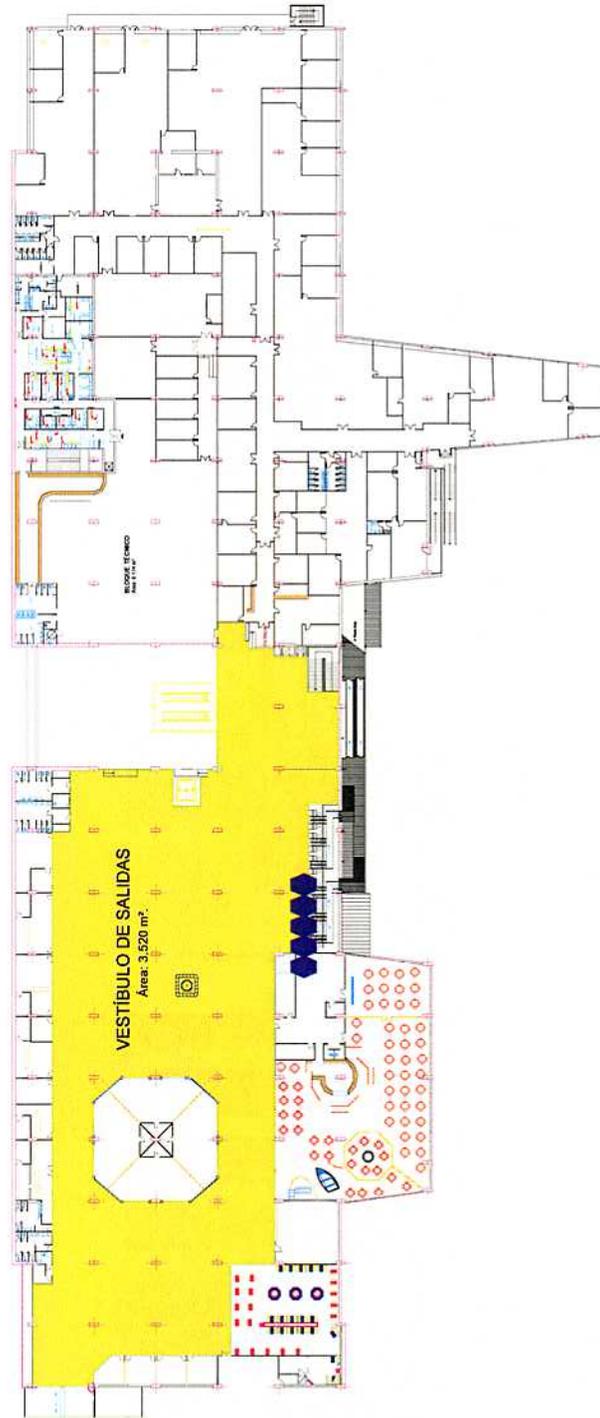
Instalaciones actuales planta alta T1 (2004)
